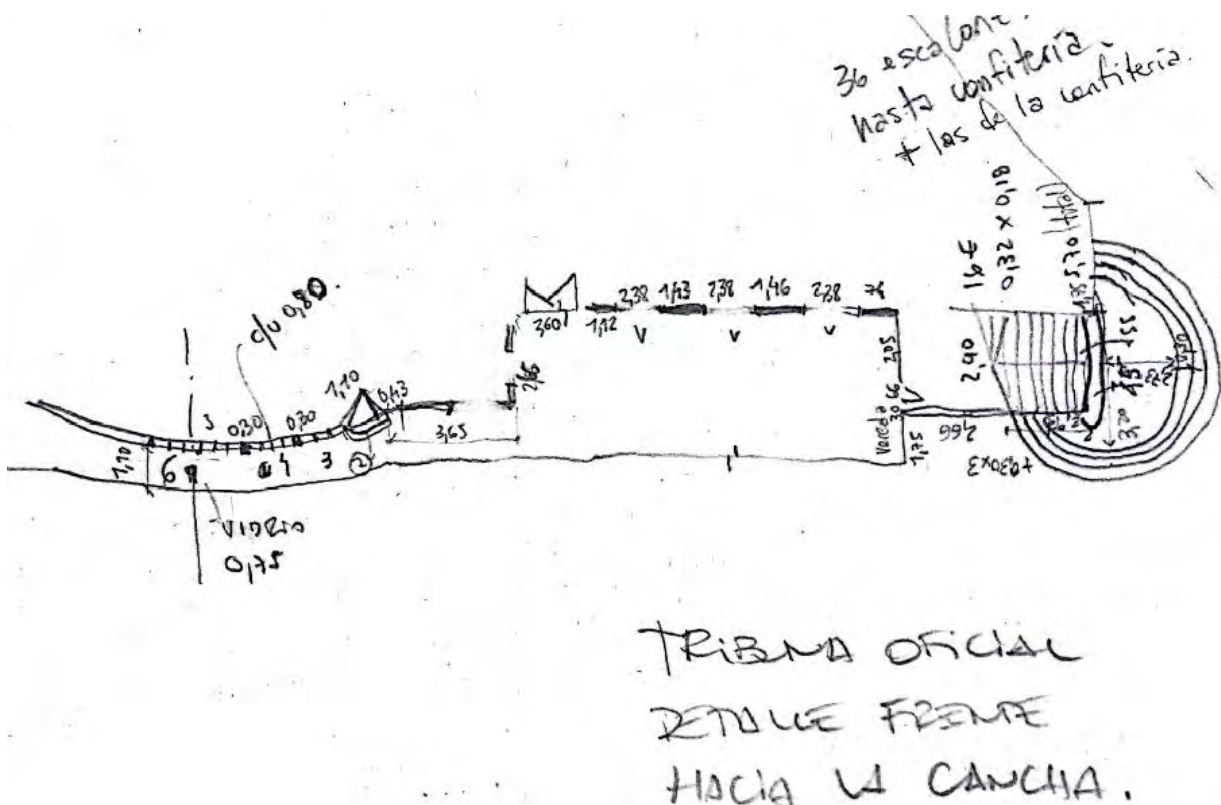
Plano Tribuna Oficial. Planta Baja. Detalle de escalera lateral. Confeccionado a partir del relevamiento realizado.
